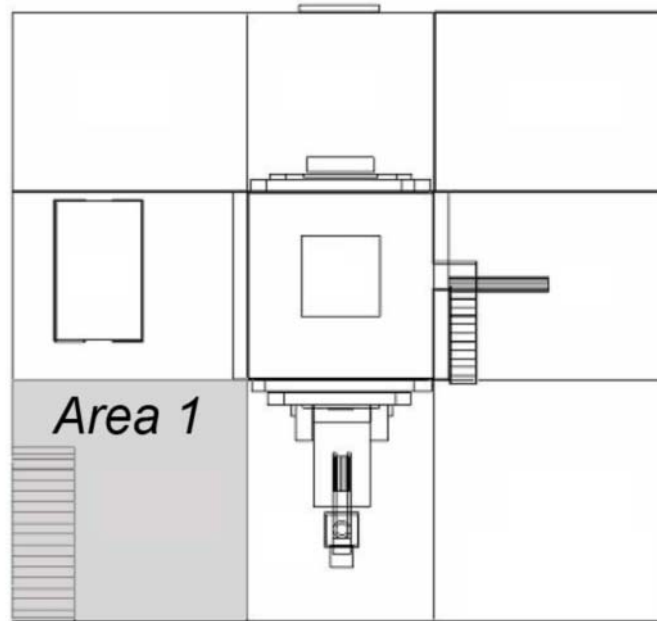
Área 1(hachurada) na planta do salão do reator
